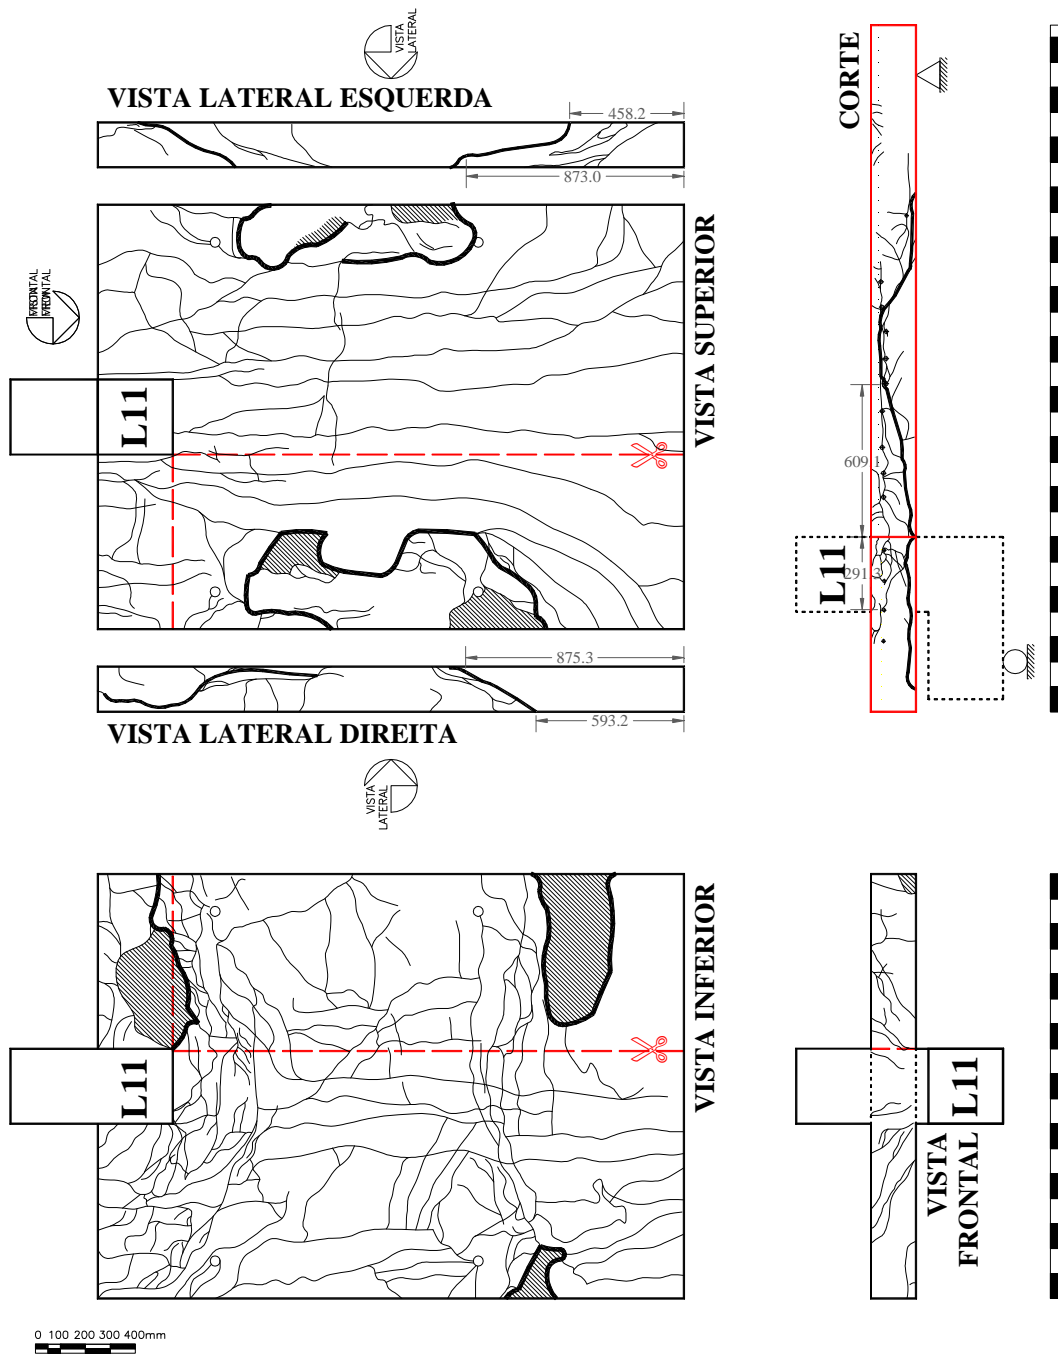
Padrão de fissuração da laje L11
